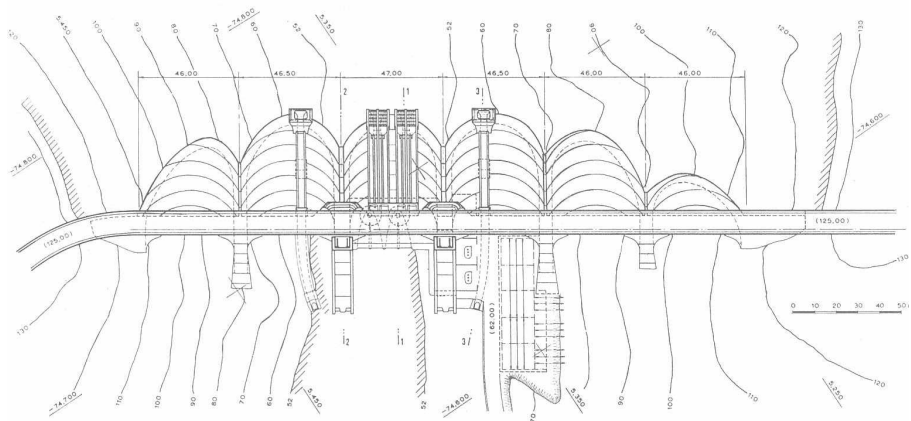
Planta da Barragem da Aguieira (1962 - não construída)
